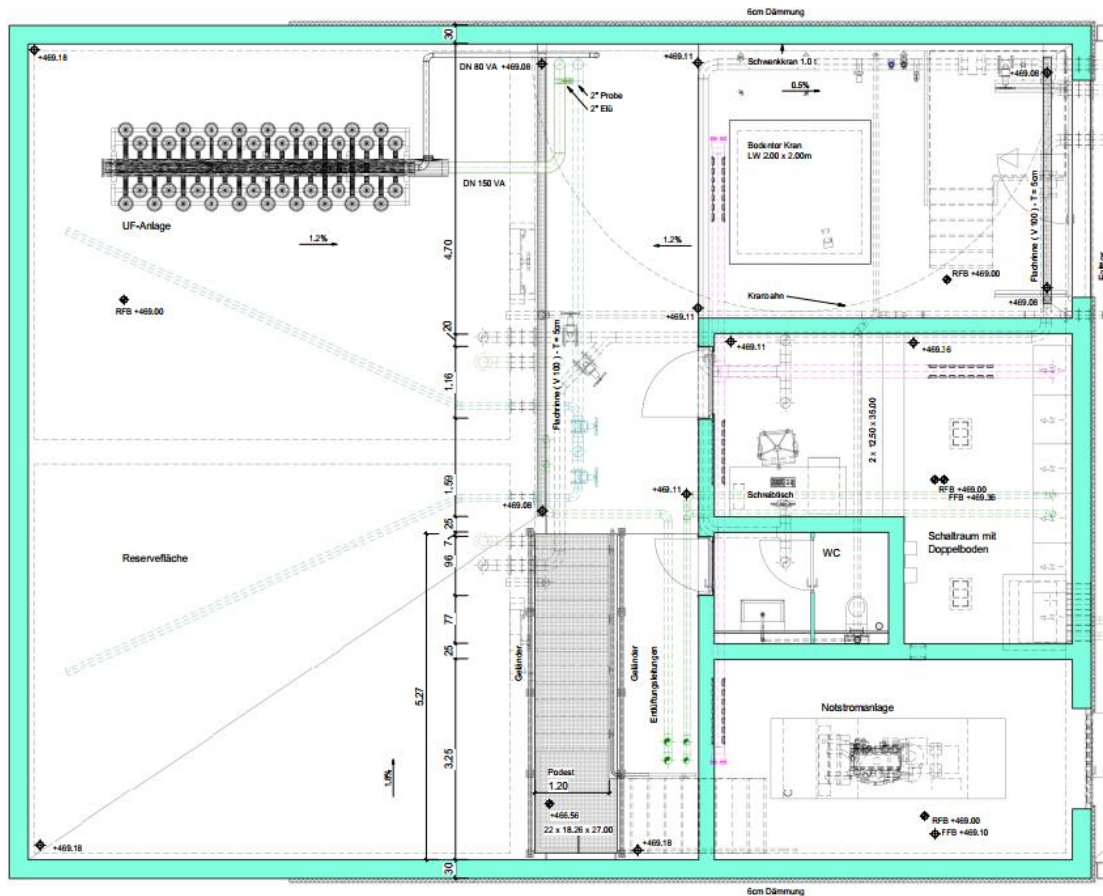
Schnitt Erdgeschoss Pumpstation aus Planbeilage L3786.302.
